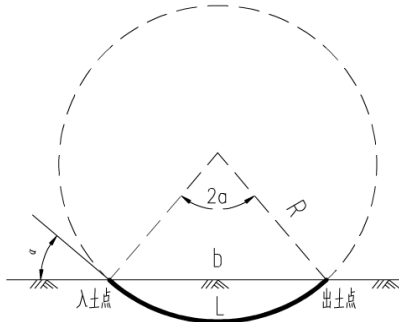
无直线段入 (出) 土轨迹示意图
